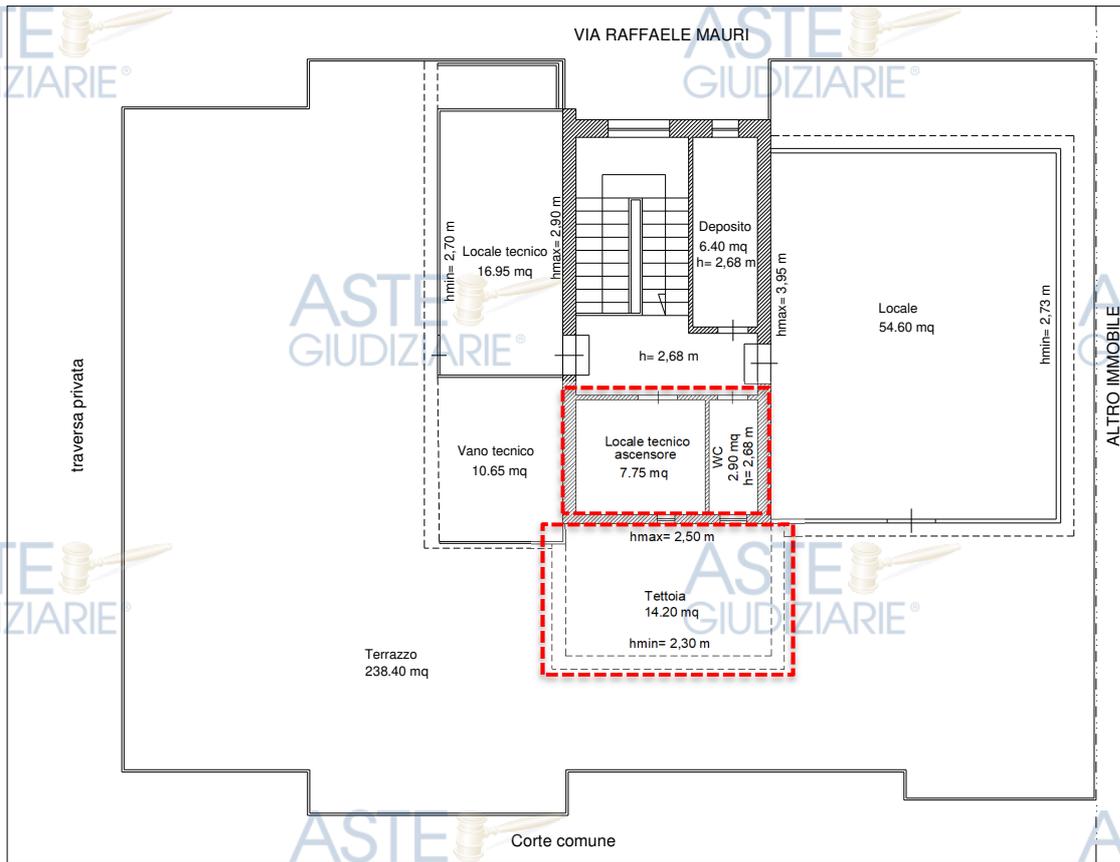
Pianta di rilievo dei locali e terrazzo afferenti – piano settimo (Lotto 1)
